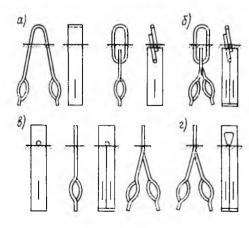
Штампованные строповочные детали, рассчитанные на подъем универсальными (стандартными) захватными устройствами
